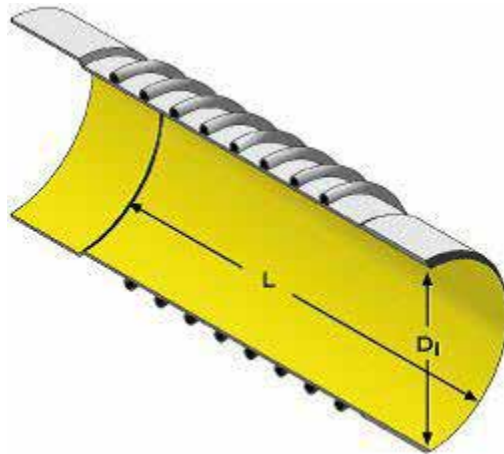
Longitud y Diámetro Nominal de tuberías KRAH® Estructurada
